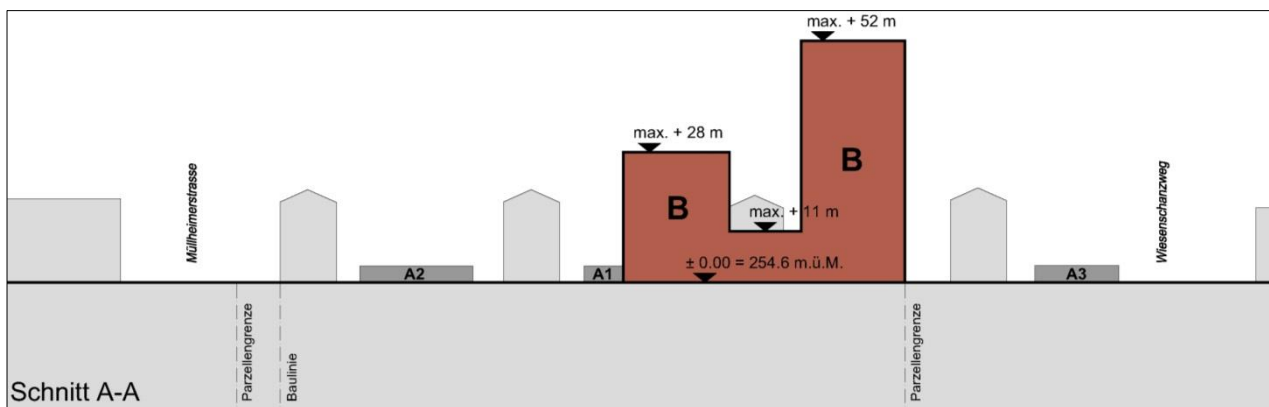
Bebauungsplan Nr. 14'281, Profil A-A (kein Massstab, Plan genordet)
